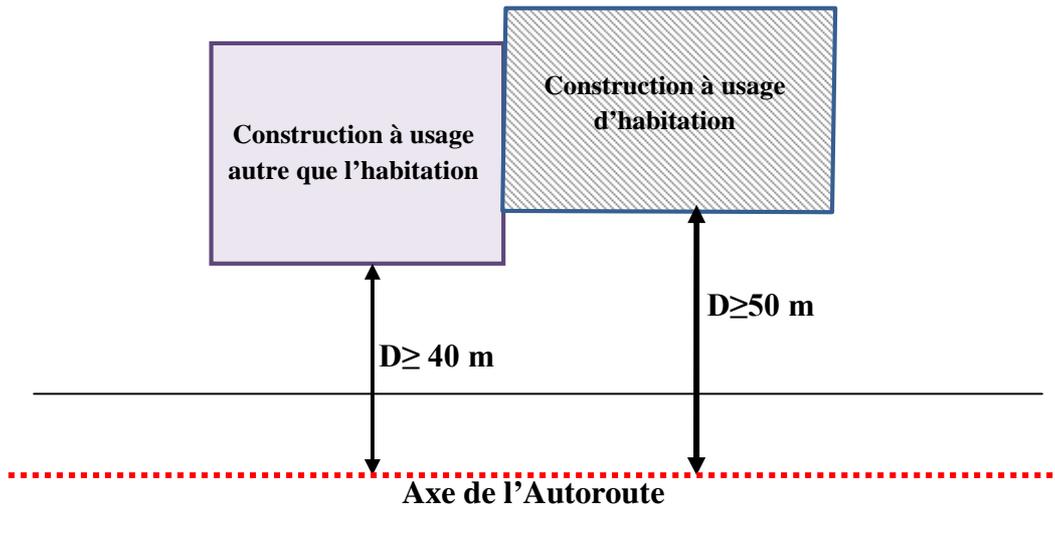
Vue en Plan définissant le recul ou la servitude d'une construction par rapport à une autoroute
